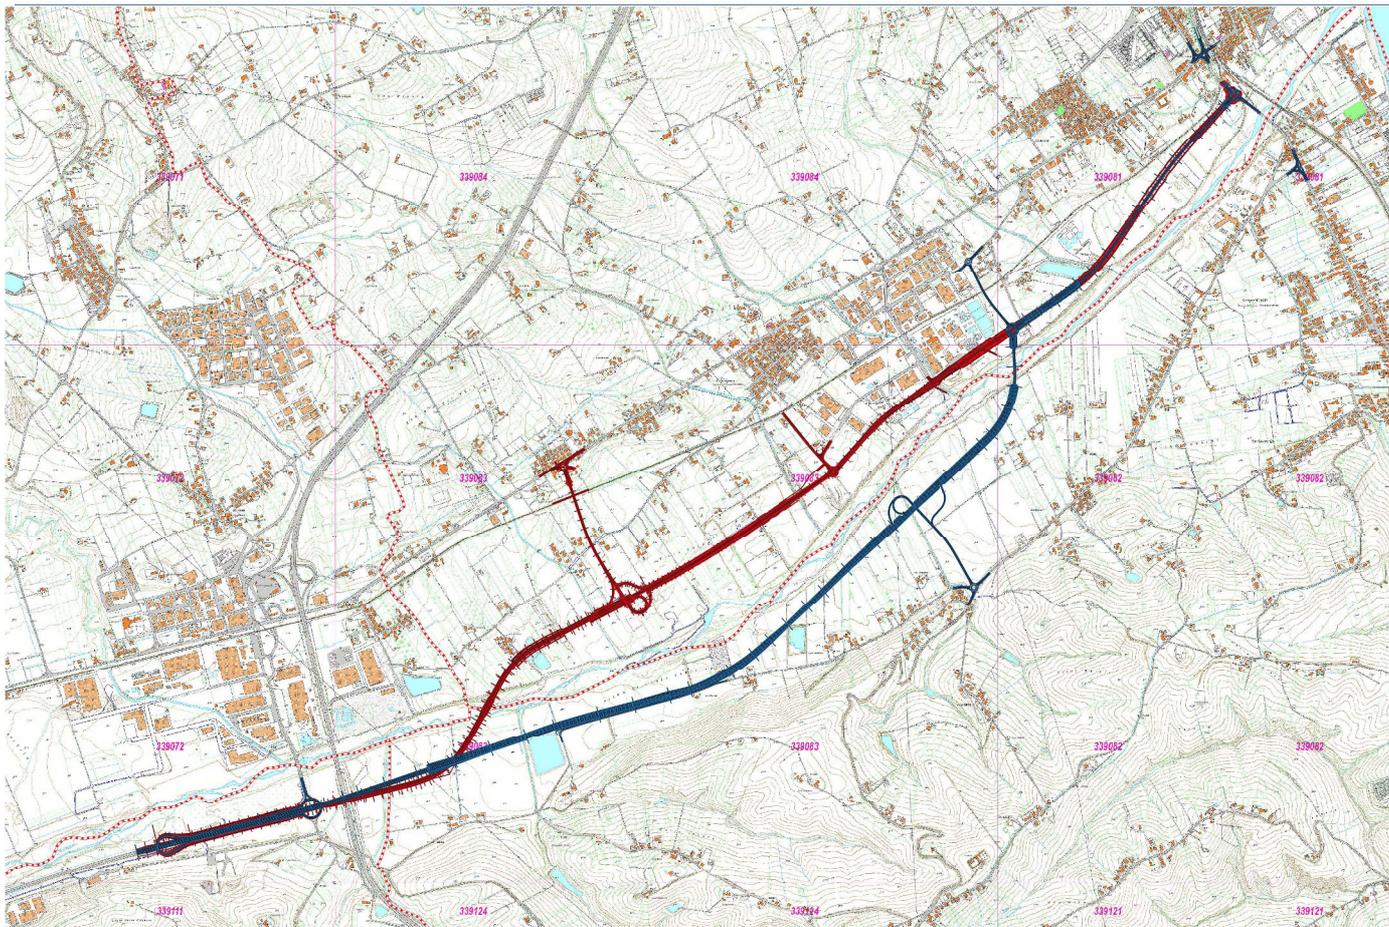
I due progetti sovrapposti alla planimetria su base CTR. In rosso la Soluzione 1, in blu la Soluzione 2
